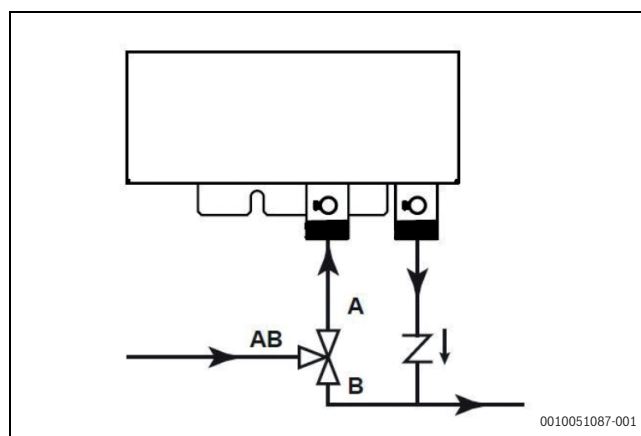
Instalação de válvula de 2 ou 3 vias a montante
